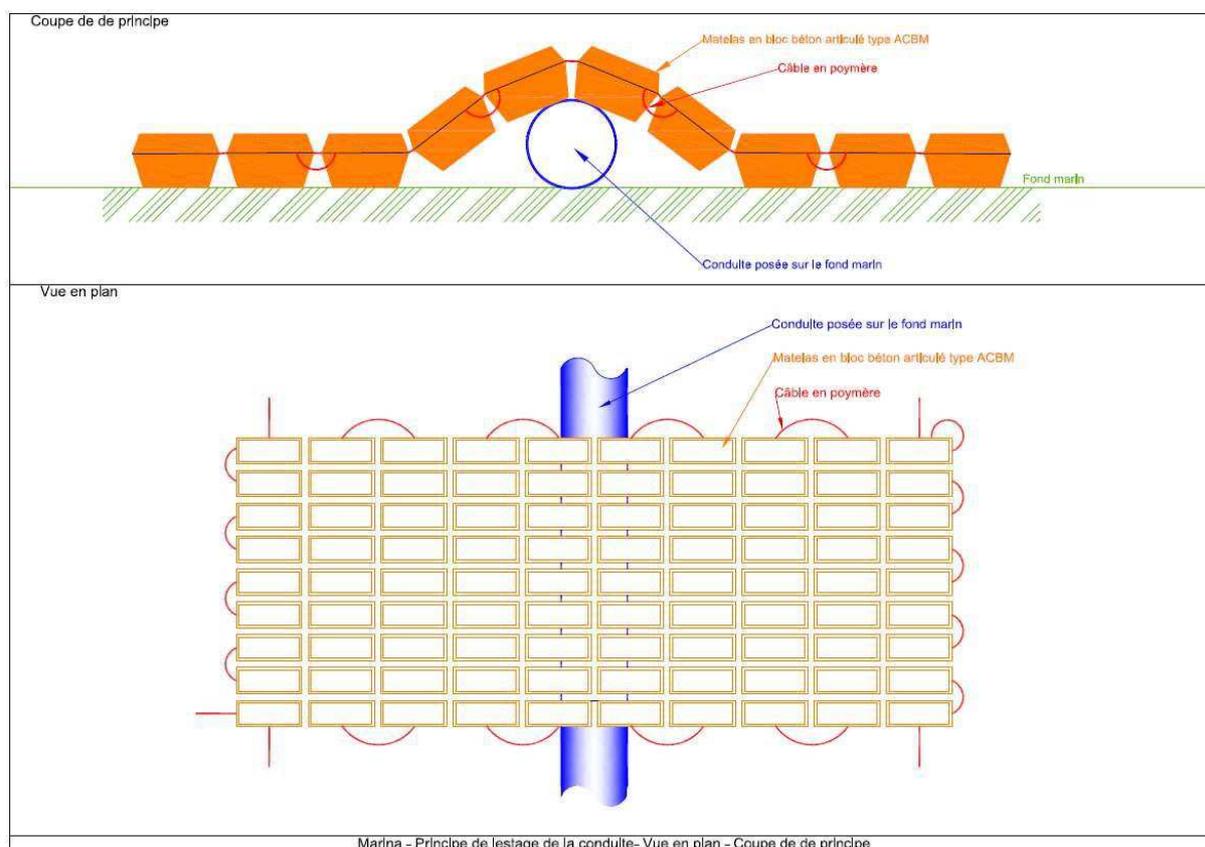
Schéma de principe de la mise en place de protections sur les conduites de pompage et rejet d'eau de mer
